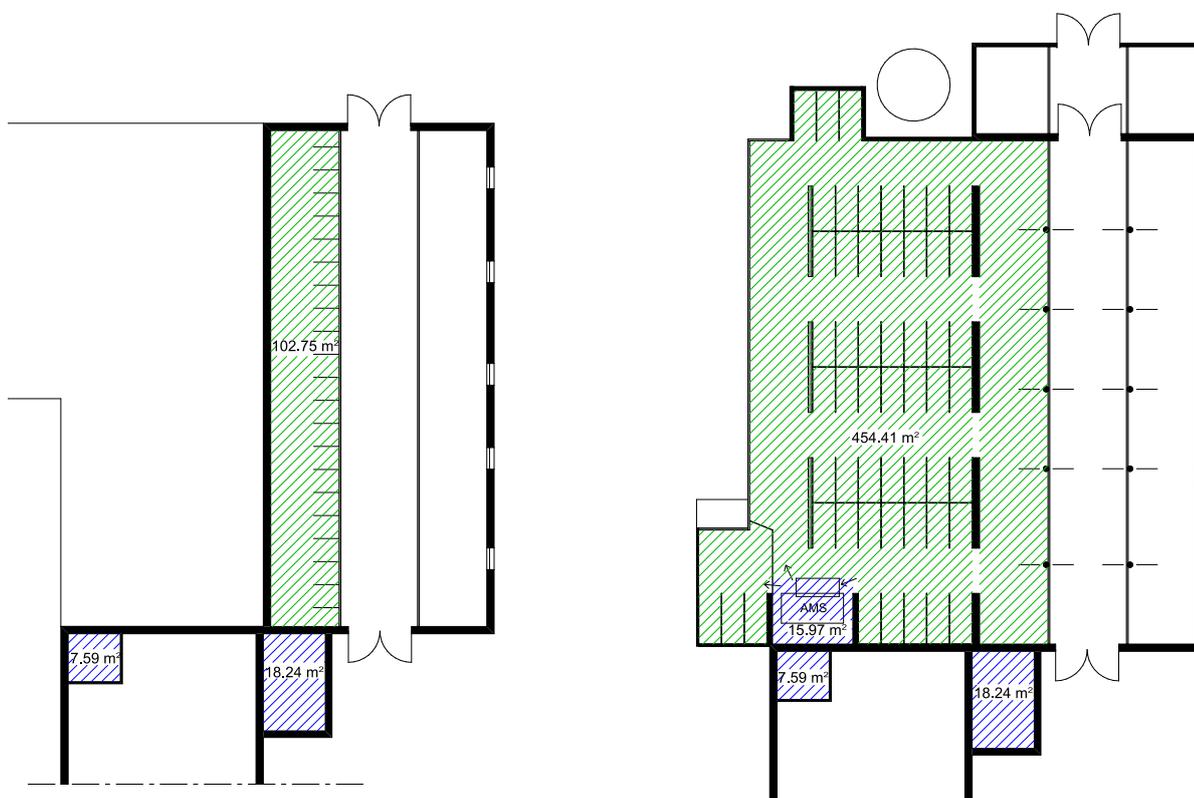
Netto-Grundflächen Betrieb D vor (links) und nach (rechts) dem Umbau, blau schraffiert = Milchkammer/Technik/Nebenräume und Melken, grün schraffiert = Stallbereich Milchkühe
